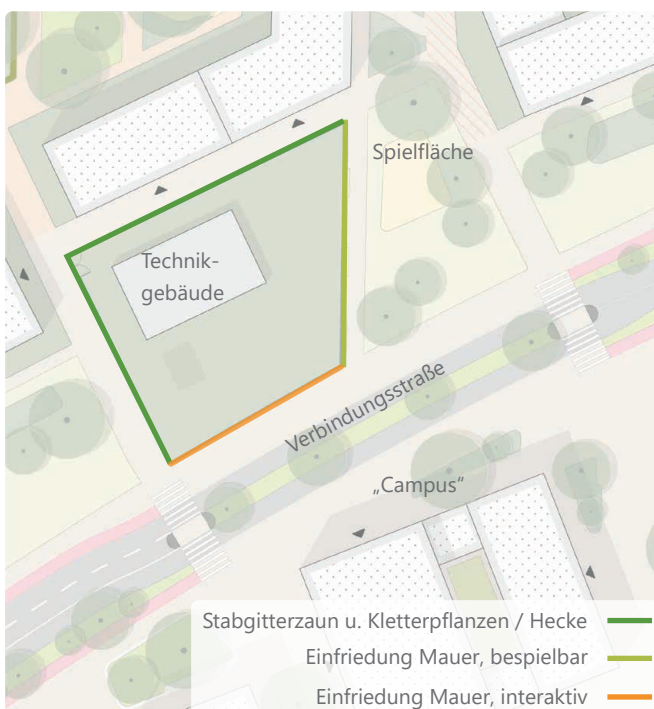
Lageplanausschnitt – nördliches Technikgebäude
